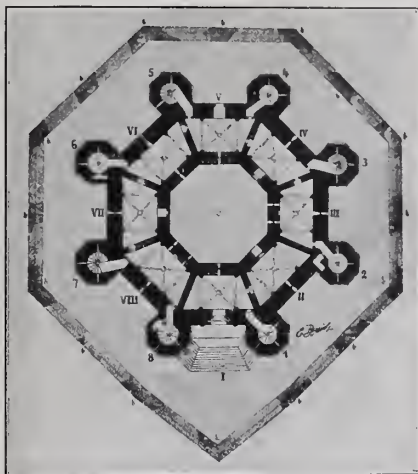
Castel del Monte. Grundriß. (Avena.)
